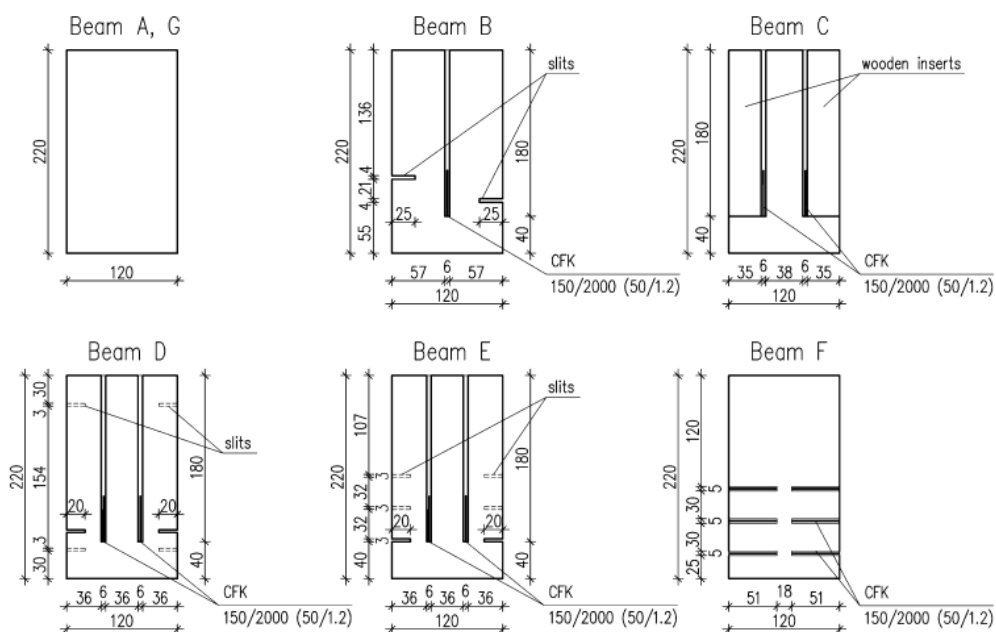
Secções transversais das vigas ensaiadas com a disposições das fibras CFRP indicadas (mm) (Jankowski et al. 2010).
